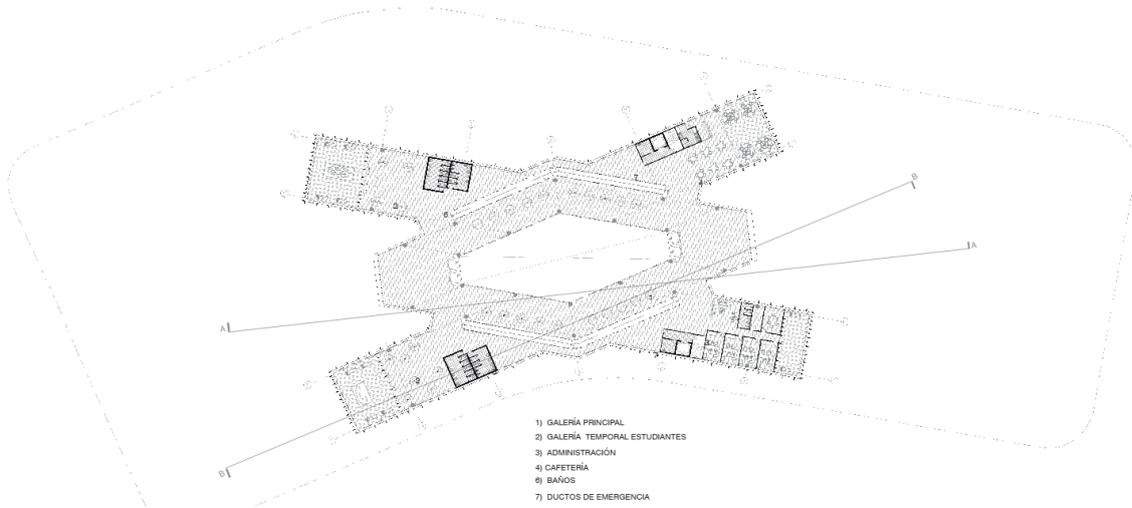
Planta PB + 7.00m. Elaboración propia
